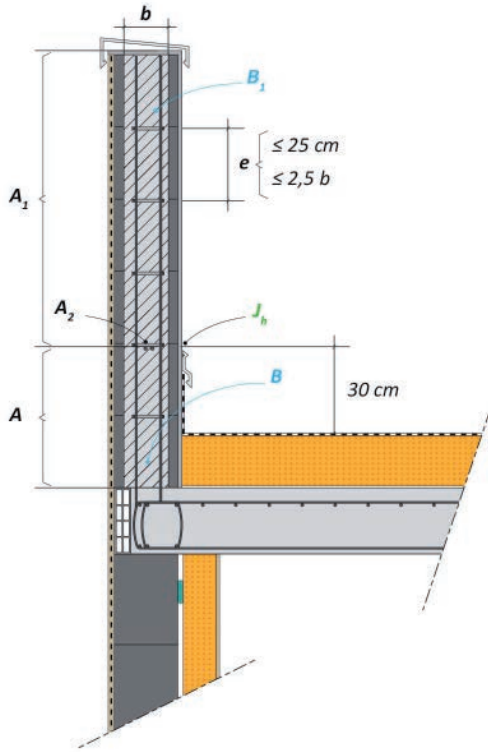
Dispositions de ferrailage des acrotères bas
